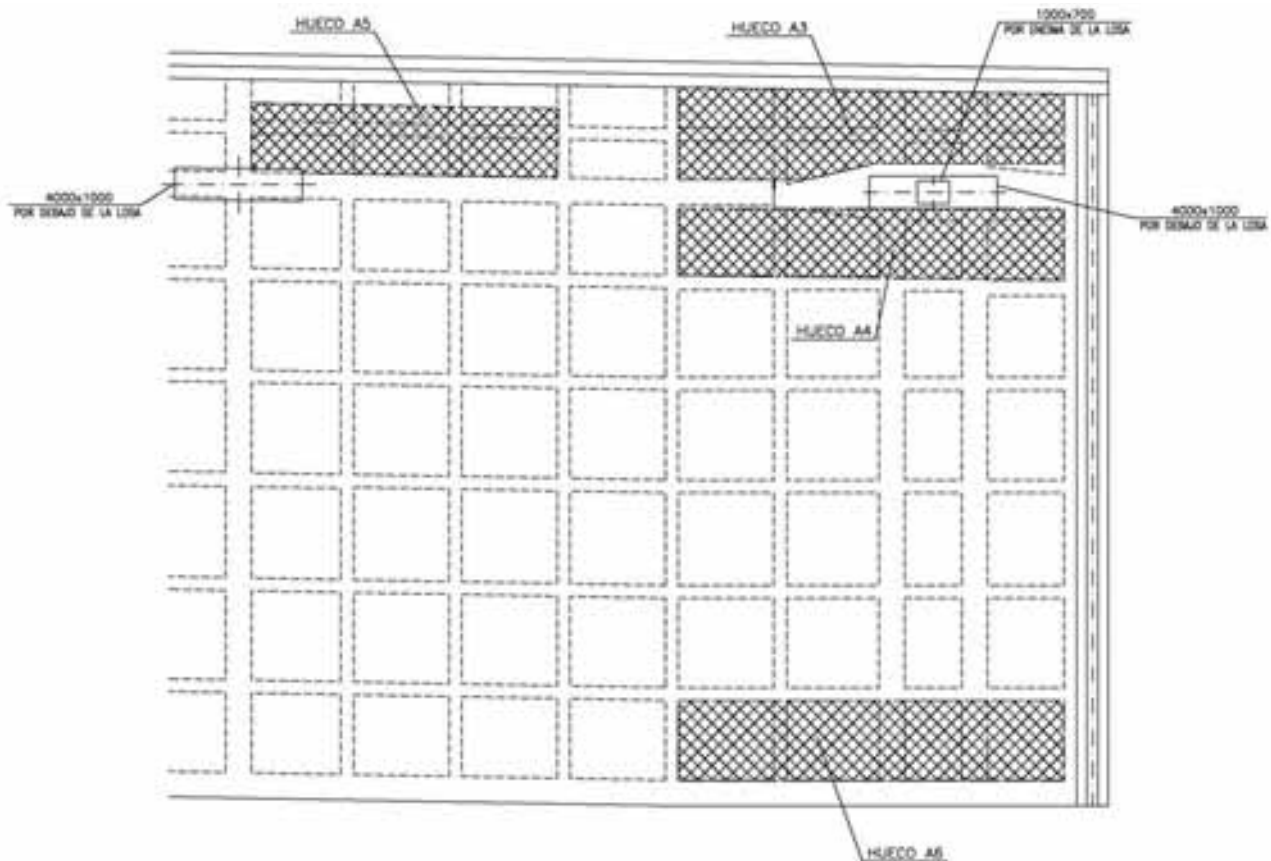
Ejemplo tipo de disposición de casetones y huecos en la losa (planta)
